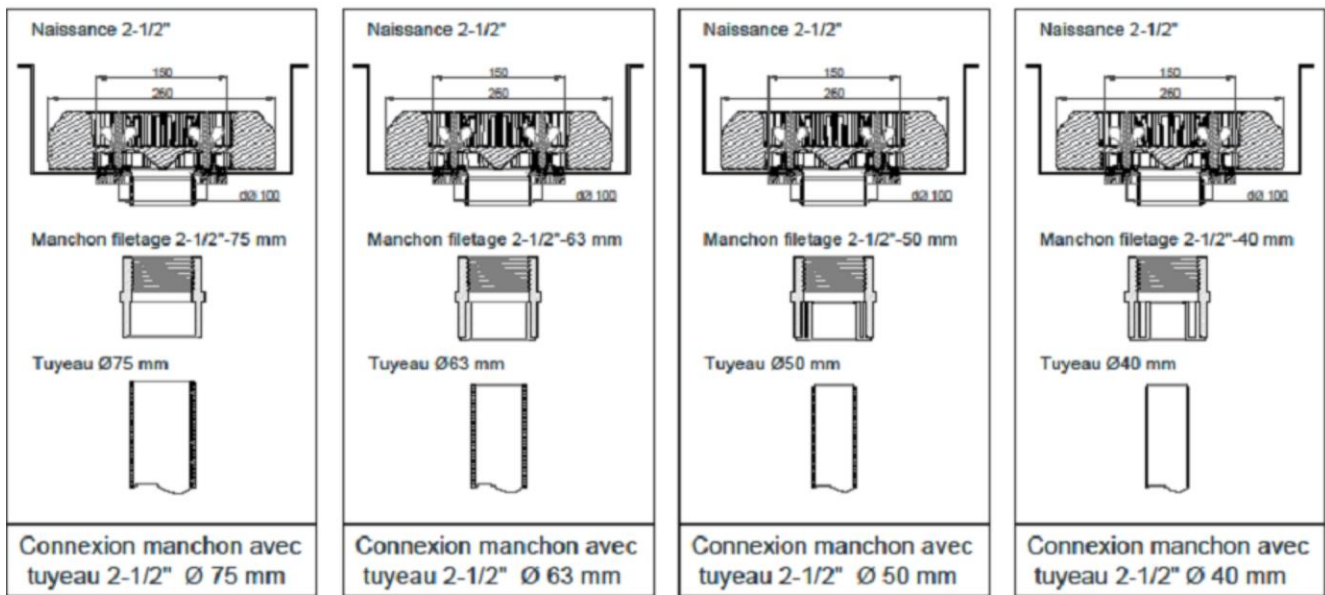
Dimensions de raccordement des flexibles en PVC-U
